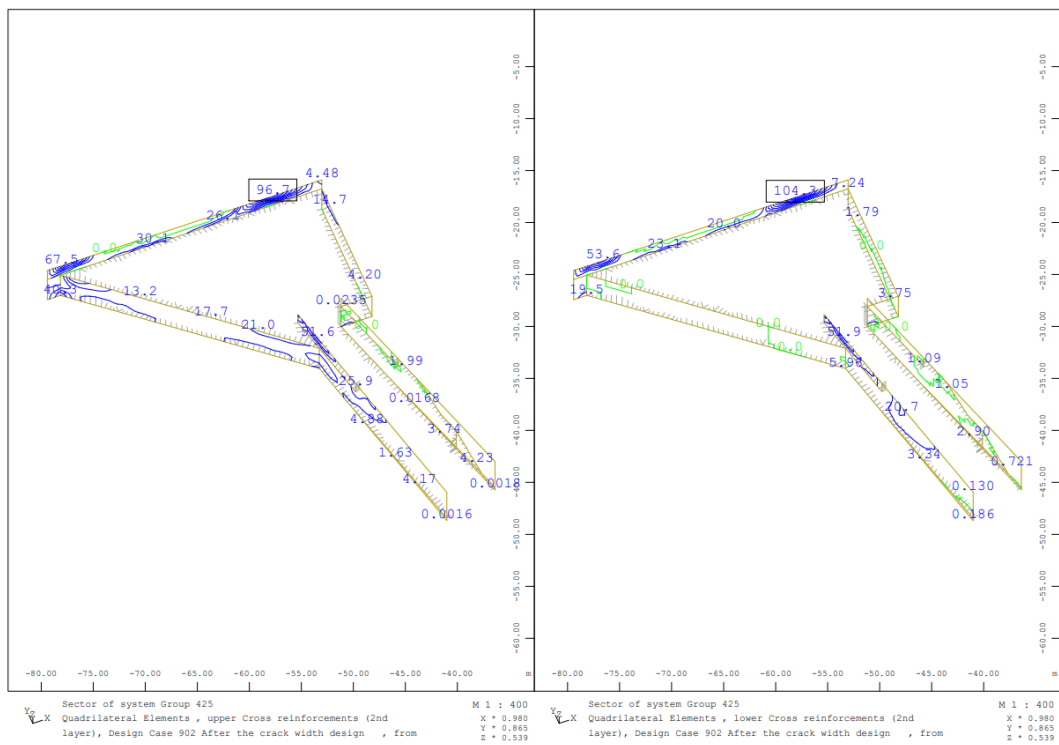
Armadura horizontal na face exterior (esq.) e interior (dir.) – muros – acesso Sul - ELS
